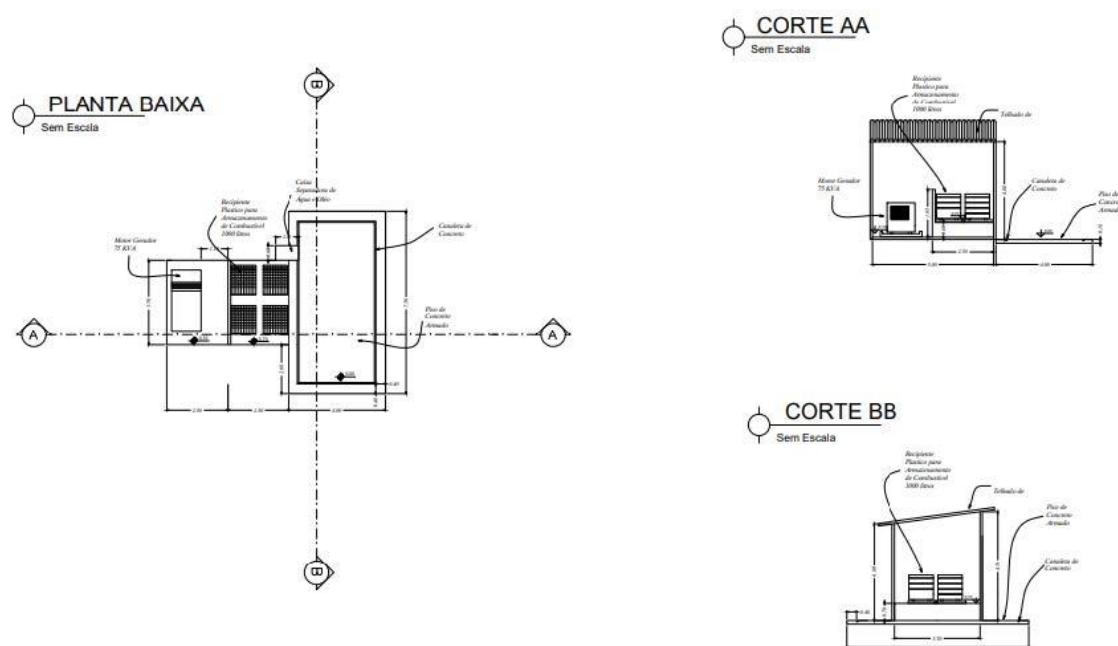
Layout do Abrigo de geradores e abastecimento de máquinas.
